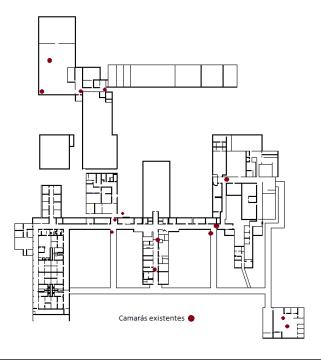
Ubicación de las cámaras de seguridad en planta baja y las áreas adyacentes
